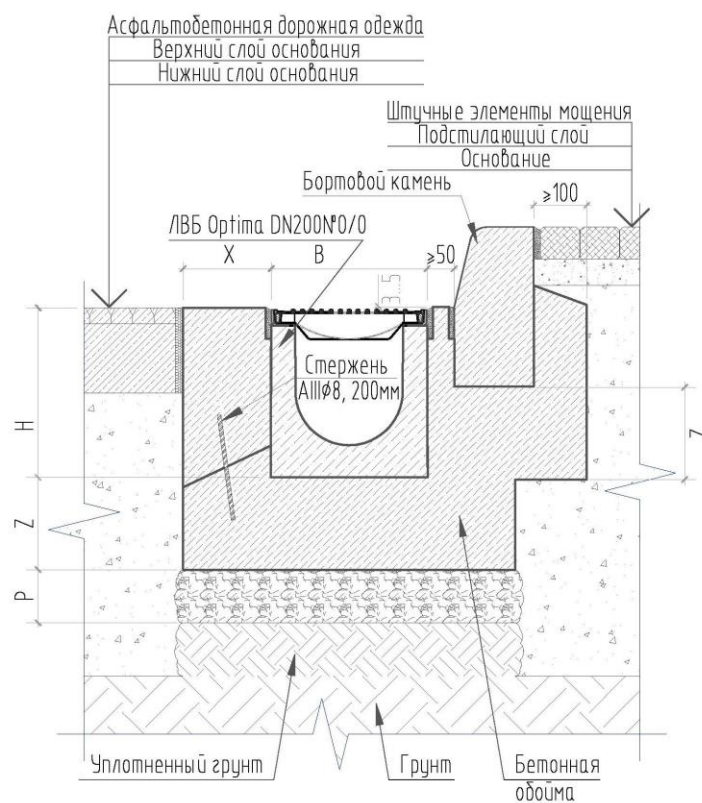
Монтаж бетонных лотков с асфальтобетонным покрытием и бортовым камнем.
